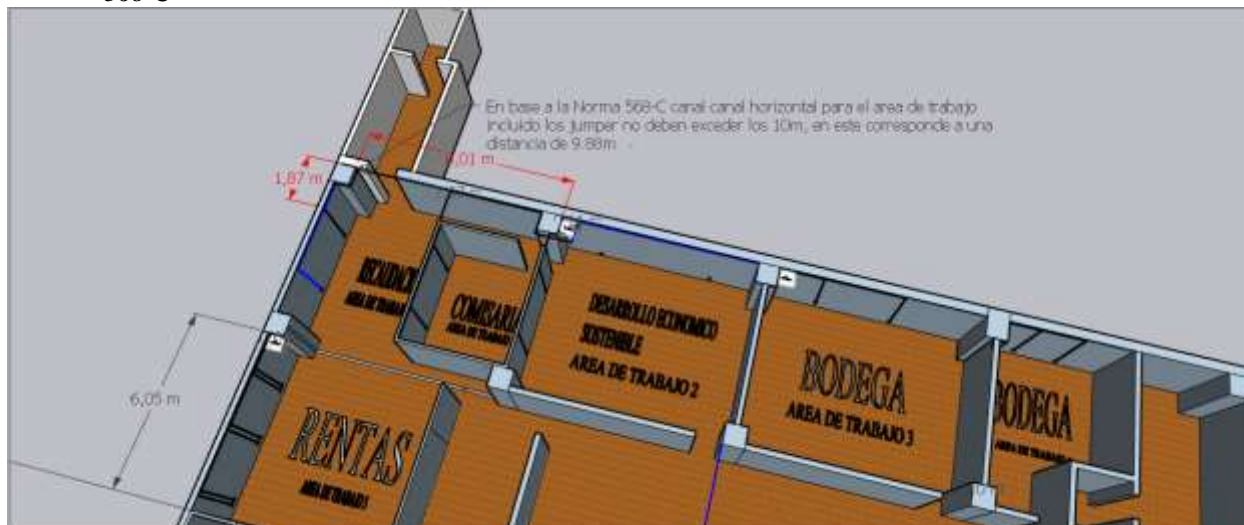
Distancia Máxima del Cableado Horizontal Planta Baja del GADMT no debe exceder los 90m
